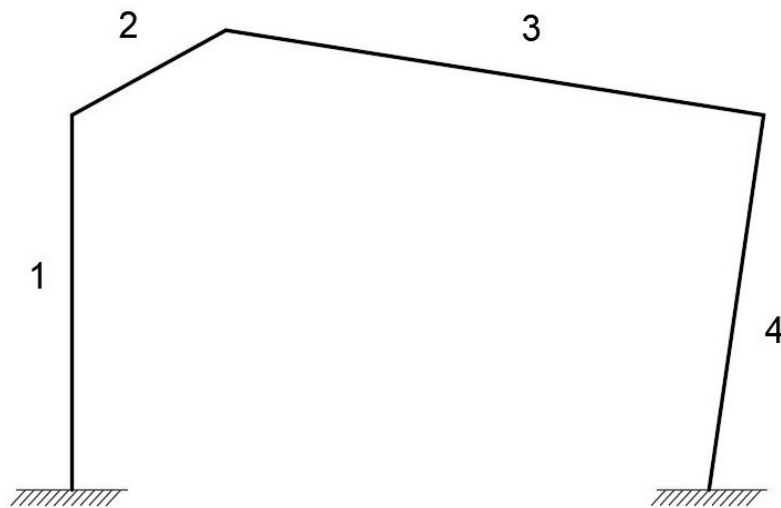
Primera fase del análisis estructural de elementos esenciales.
